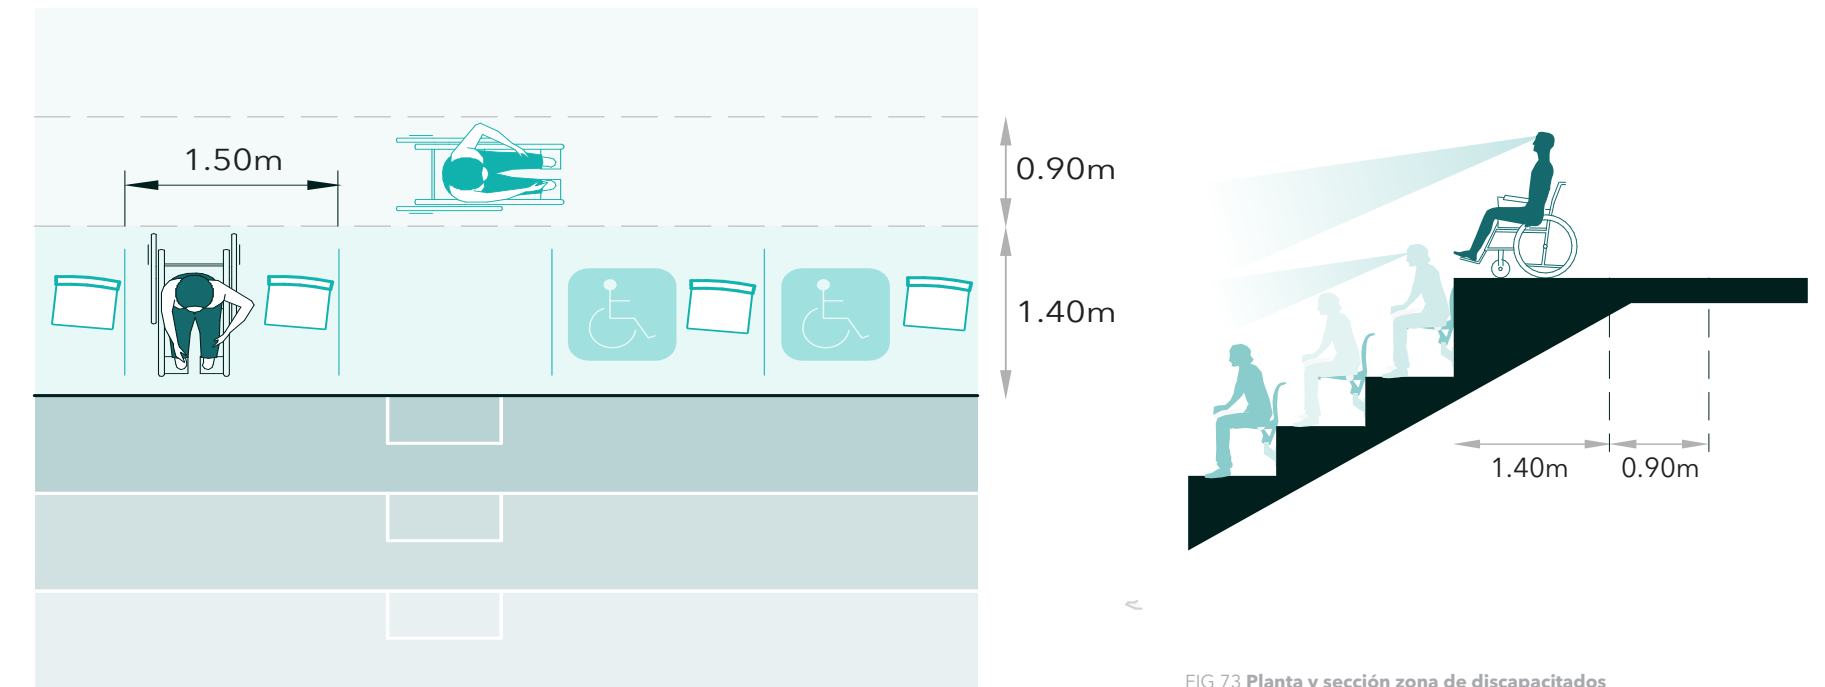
Planta y sección zona de discapacitados Fuente: Elaboración propia
